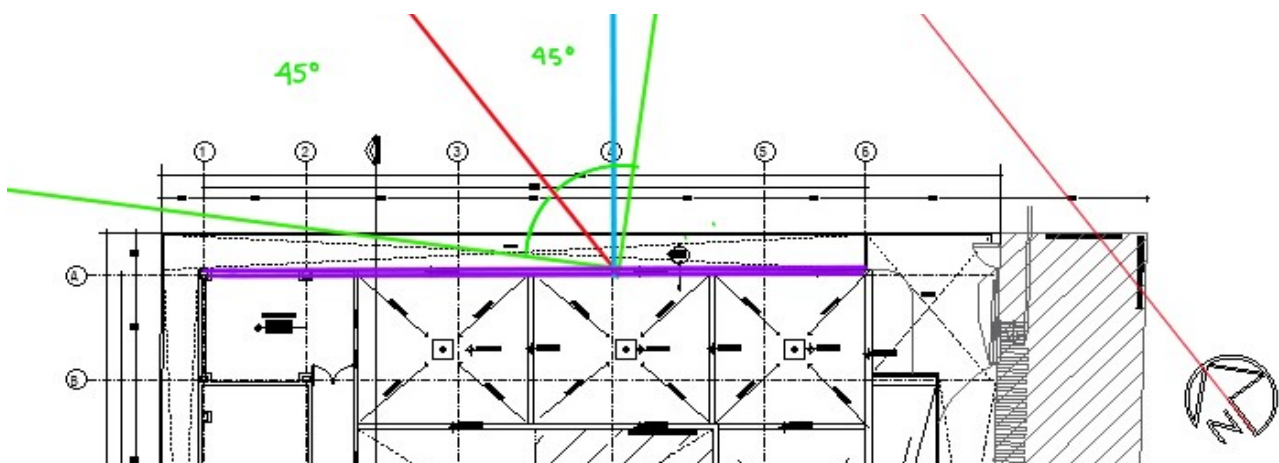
Ejemplo de Determinación de fachada norte del CENDI
